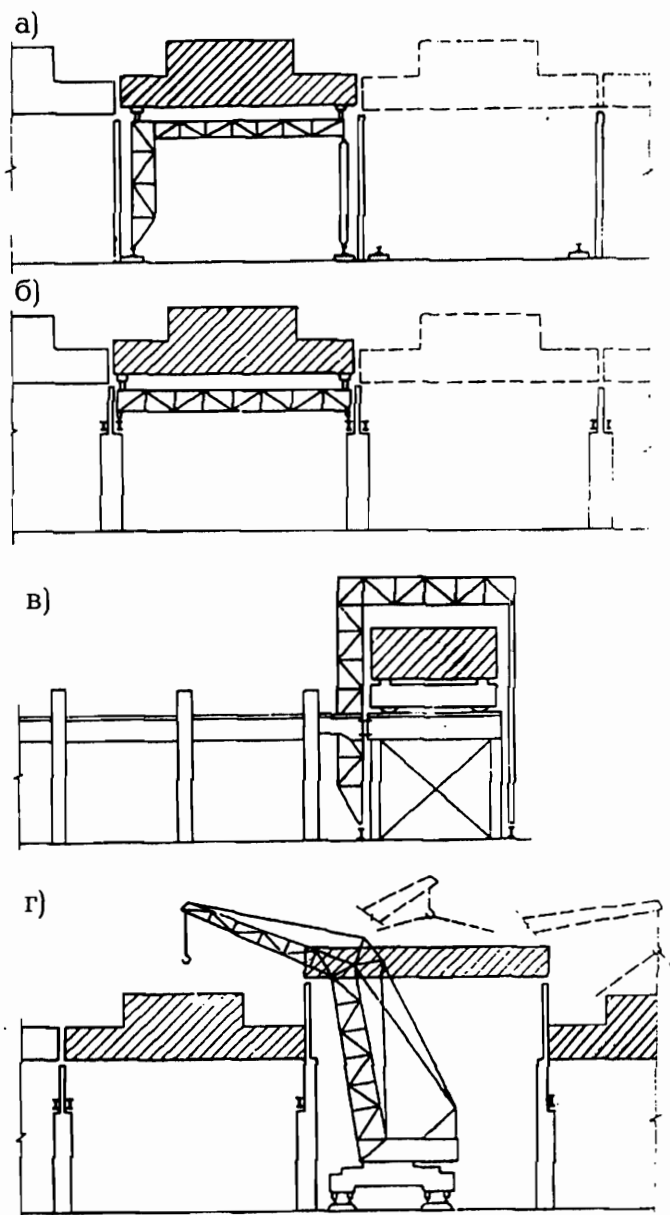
Транспортирование и установка блоков покрытия: а – высоким установщиком; б – низким установщиком; в – козловым краном и низким установщиком; г – универсальным монтажным или башенным краном с подачей блока по путям крана
